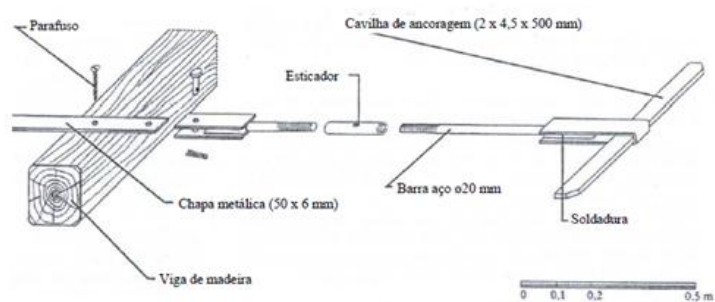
Esquema de um tirante pregado perpendicularmente às vigas de madeira [5]
